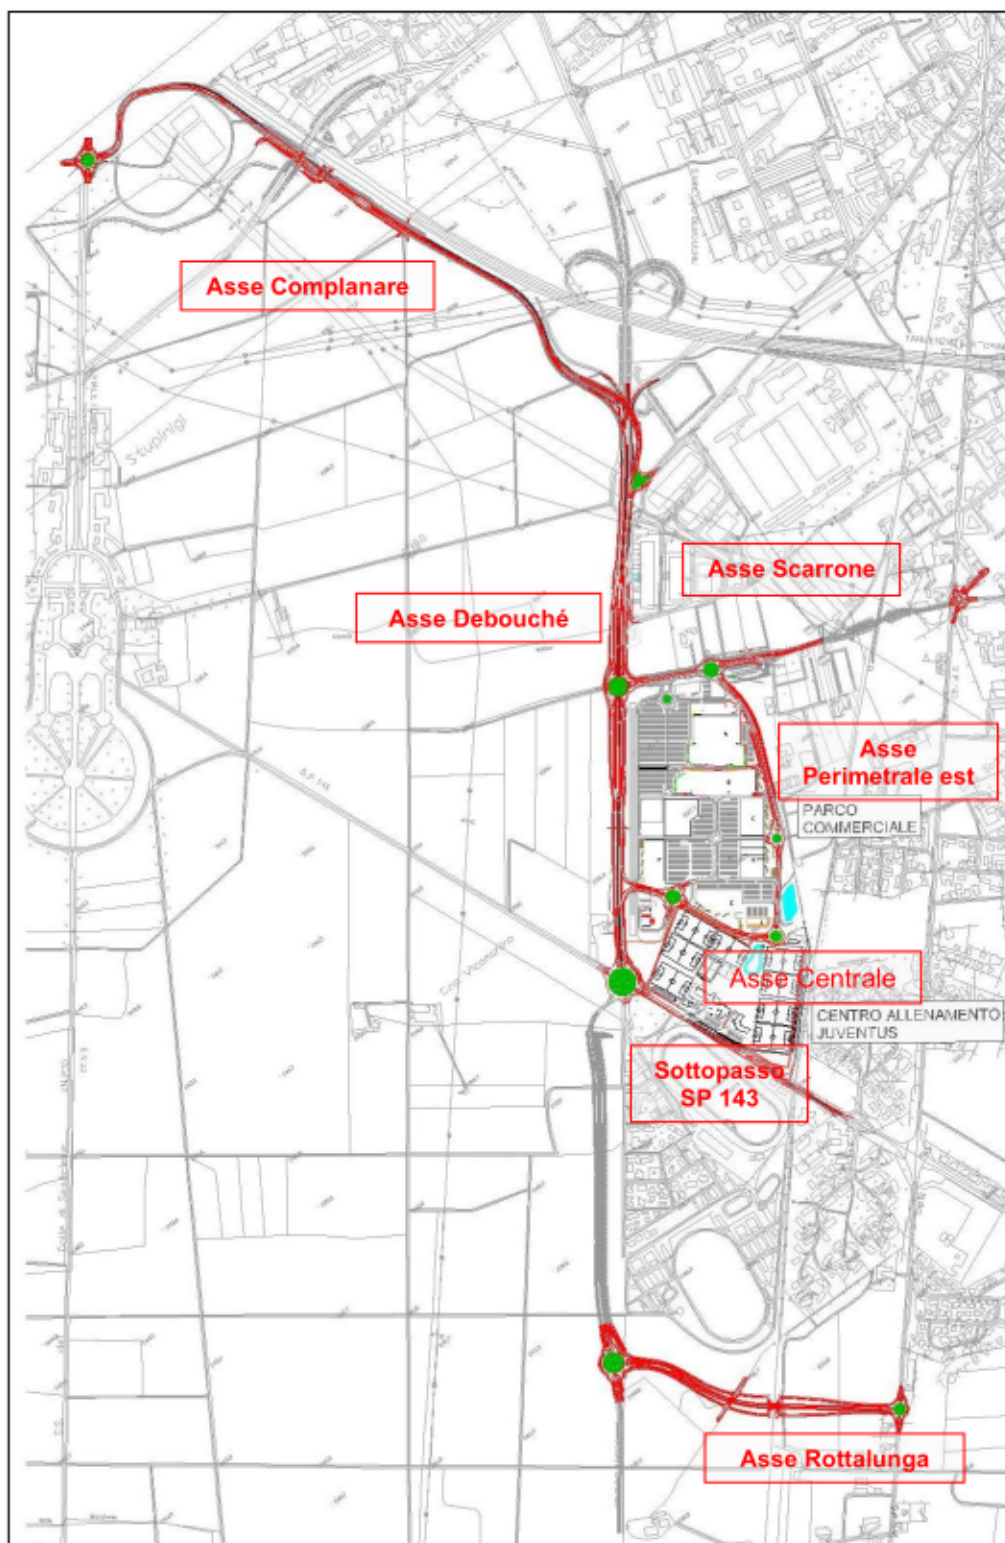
/1 Area del Parco Commerciale e viabilità connessa (progetto 2011)
